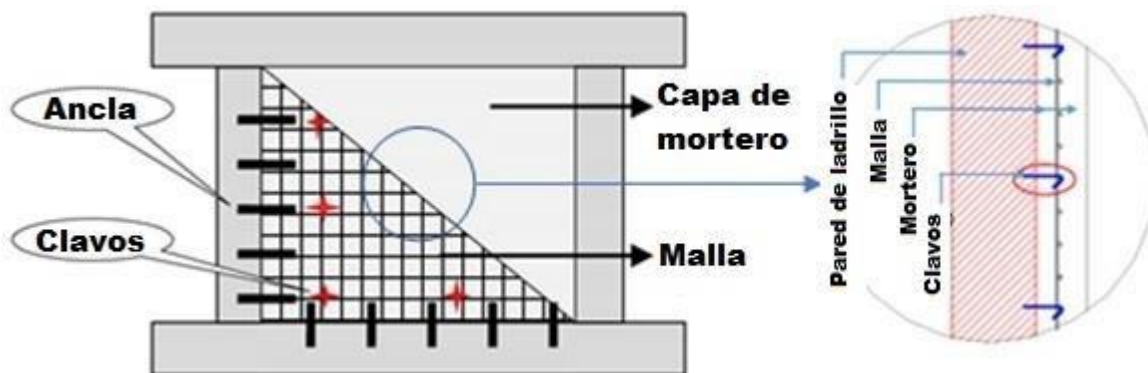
Detalle esquemático del laminado de ferrocemento.
